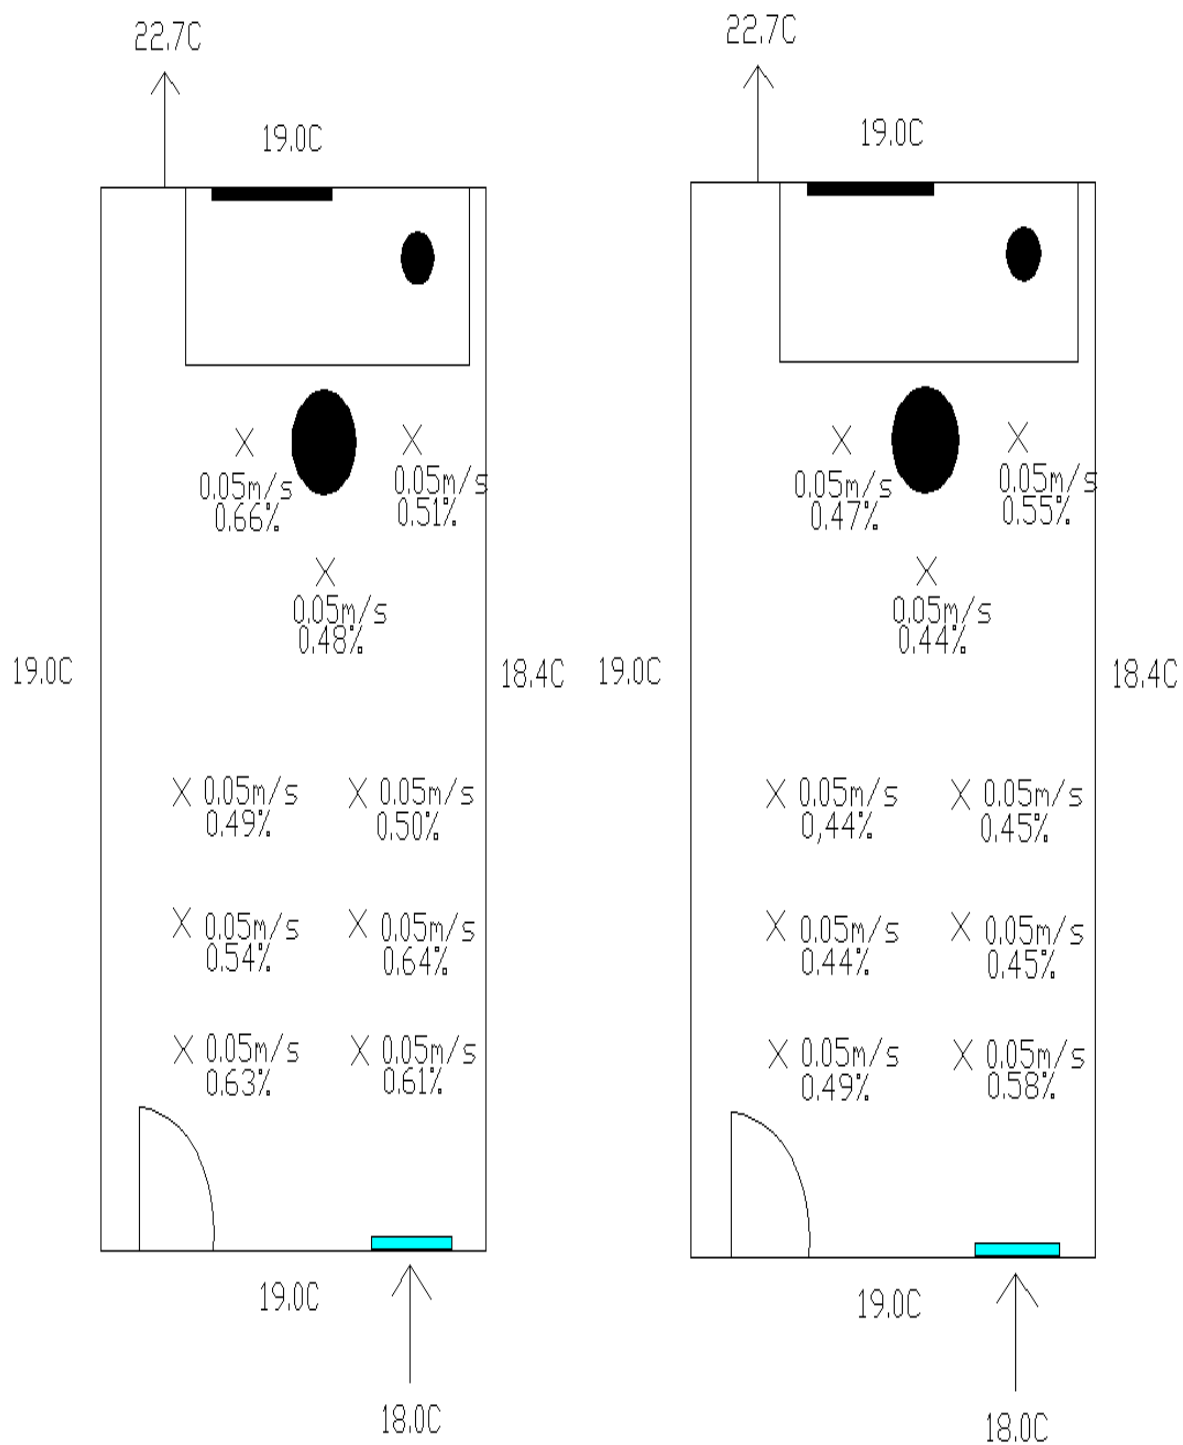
Til venstre: 60cm over gulvet. Til høyre: 110cm over gulvet.
